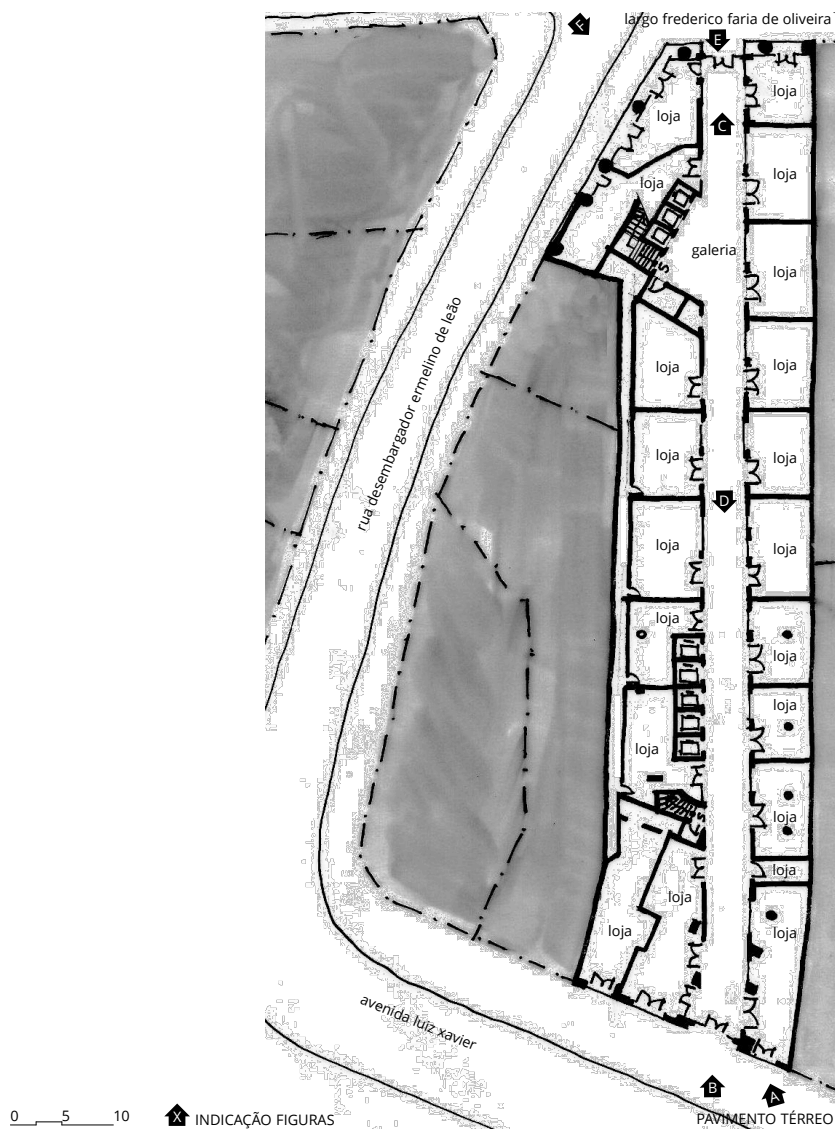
Edifício Tijucas. Planta esquemática do pavimento térreo. Croqui elaborado pelo autor, 2015.
